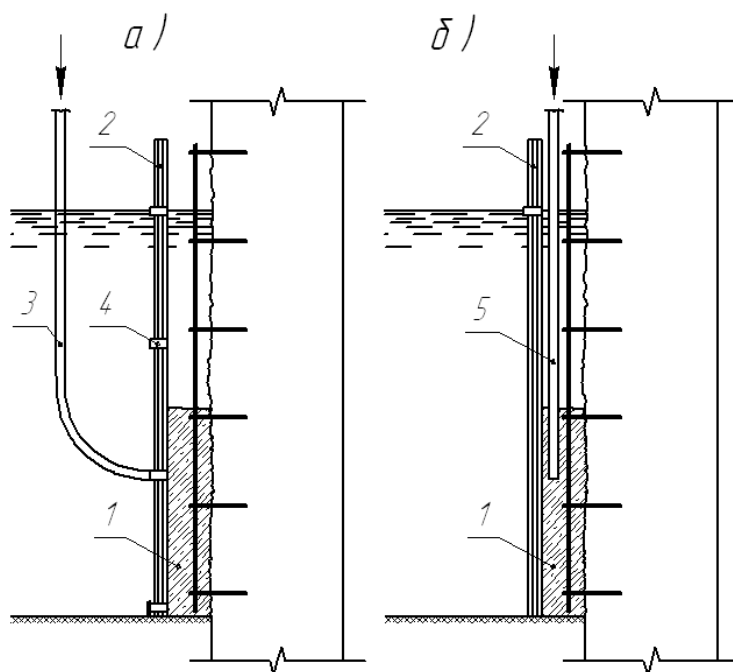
Схемы заливки массы при бетонировании методом вытеснения воды из опалубки: а) по гибкому шлангу через втулки в опалубке; б) по трубопроводу, нижний конец которого спущен в бетонную массу
